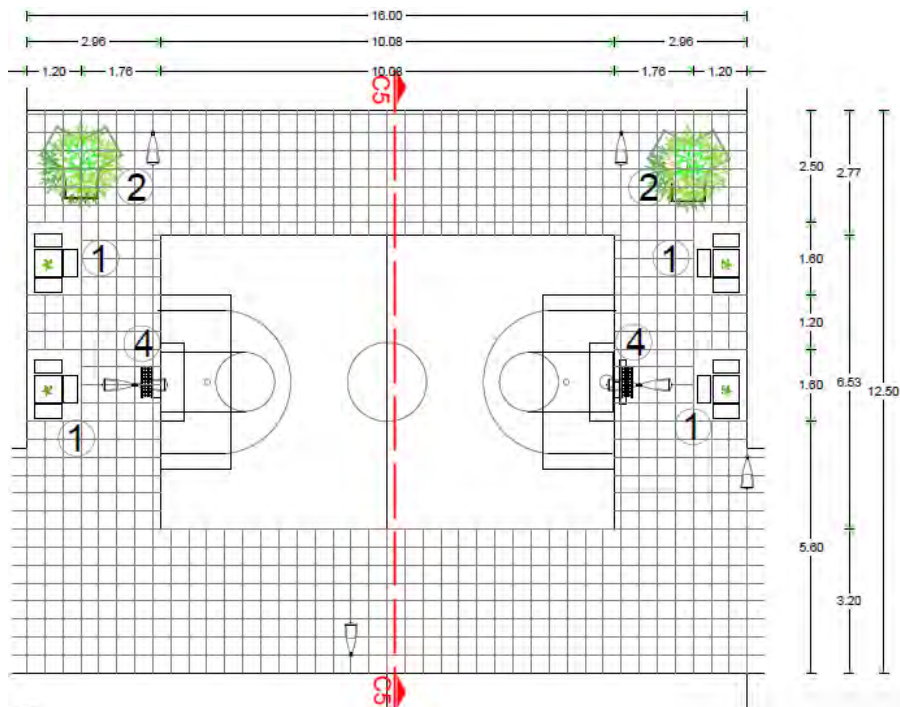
Planta arquitectónica de la plaza 12. En ella se muestra la disposición del mobiliario y el cambio de pavimentos utilizados para la diferenciación de las áreas en la plaza.
